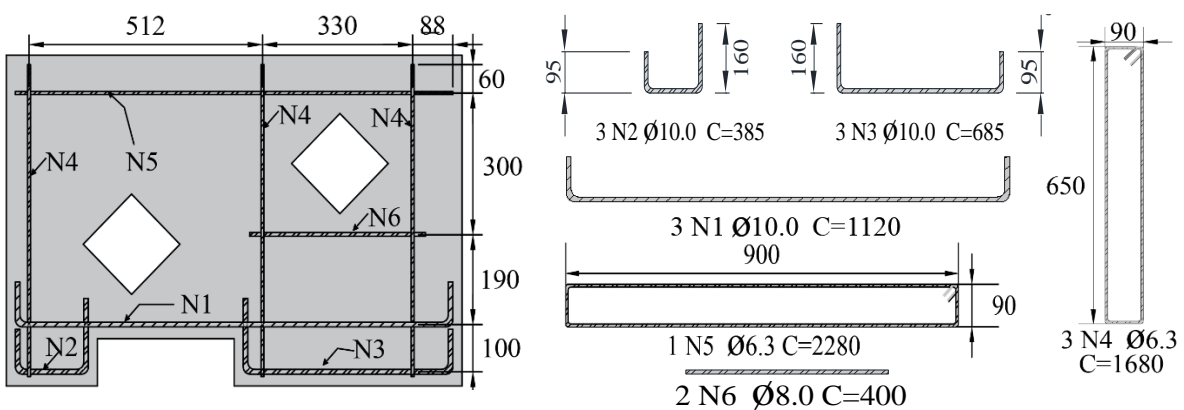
Detalhamento das armaduras DB2-W-H2-U-A (dimensões mm)
